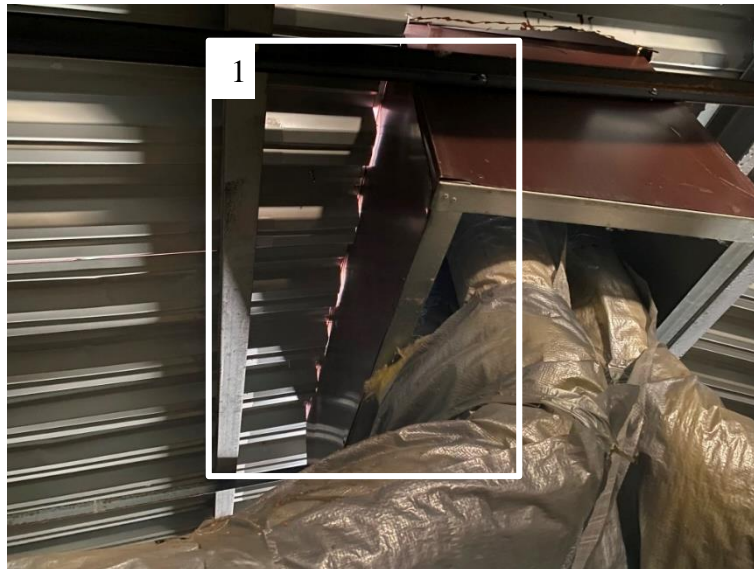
Фрагмент вида кровли. Дефекты: 1 - просветы в покрытии.
